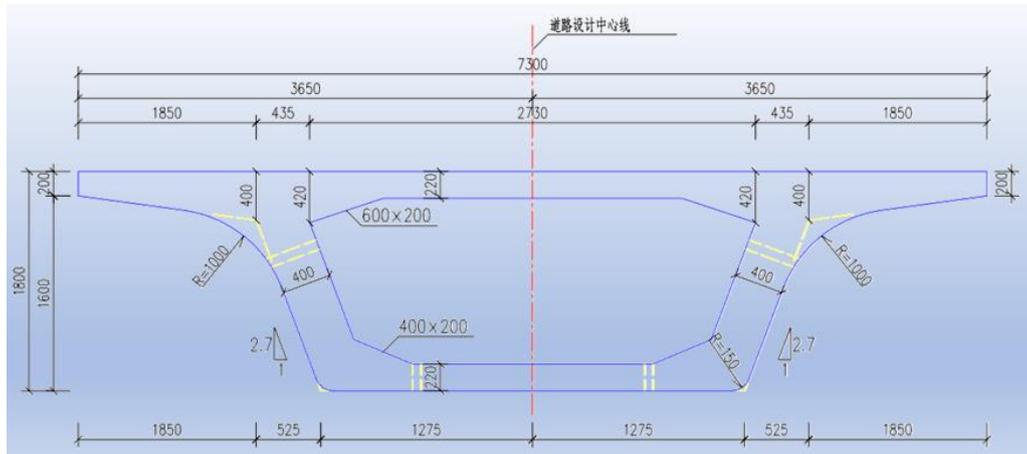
匝道 B=7.5m 预应力箱梁横断面图
